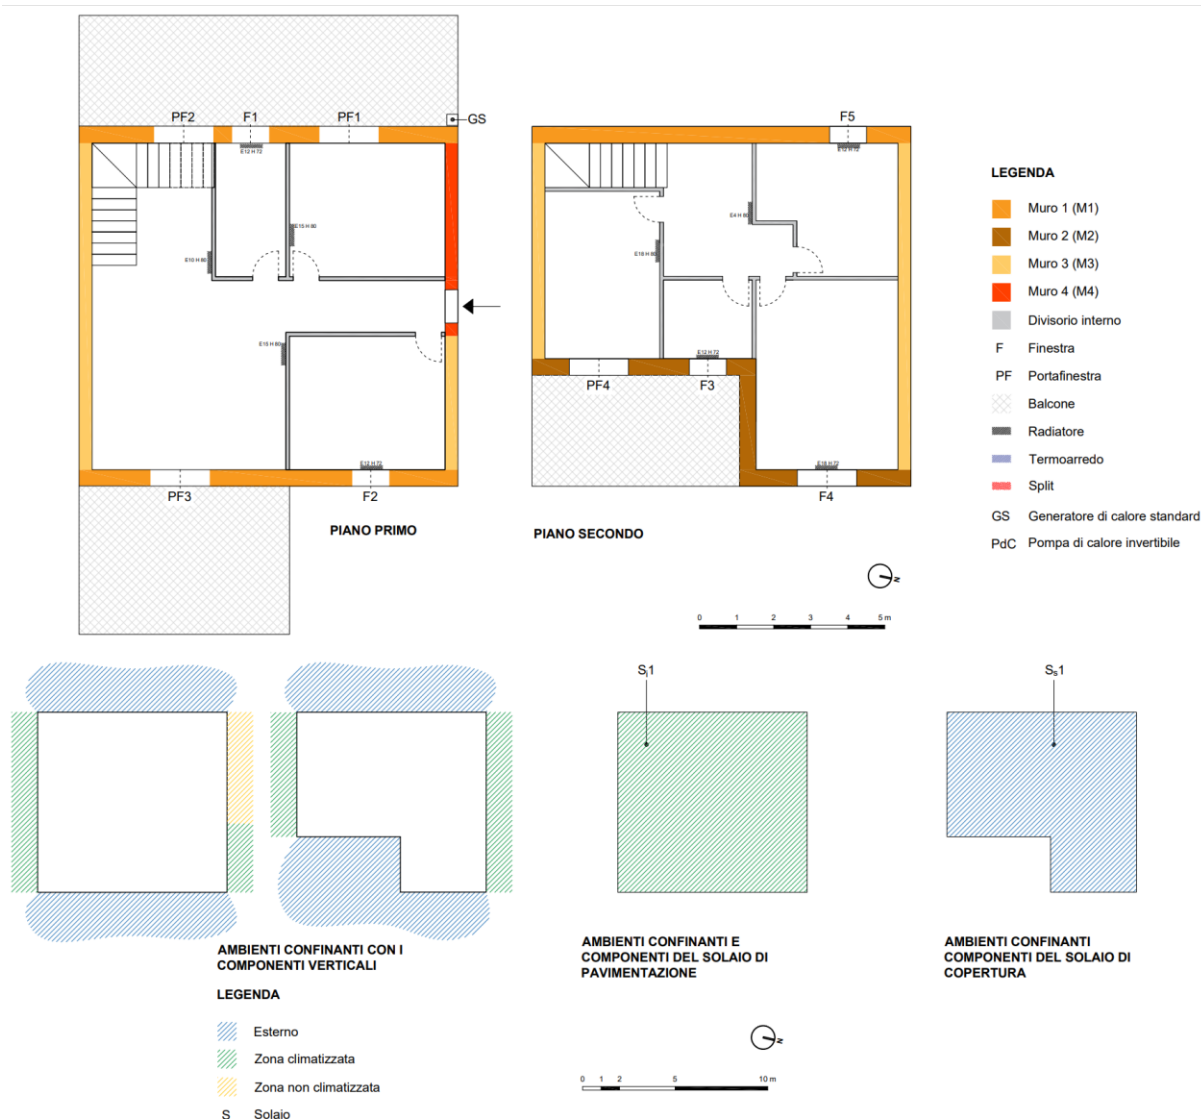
Caratterizzazione geometrica e individuazione delle zone confinanti.
